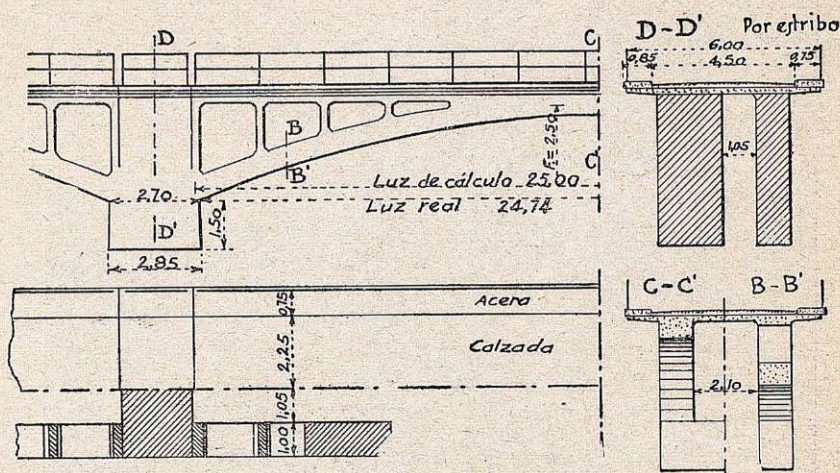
Tipo de los modelos oficiales de puentes en arco rebajados al 1/10
